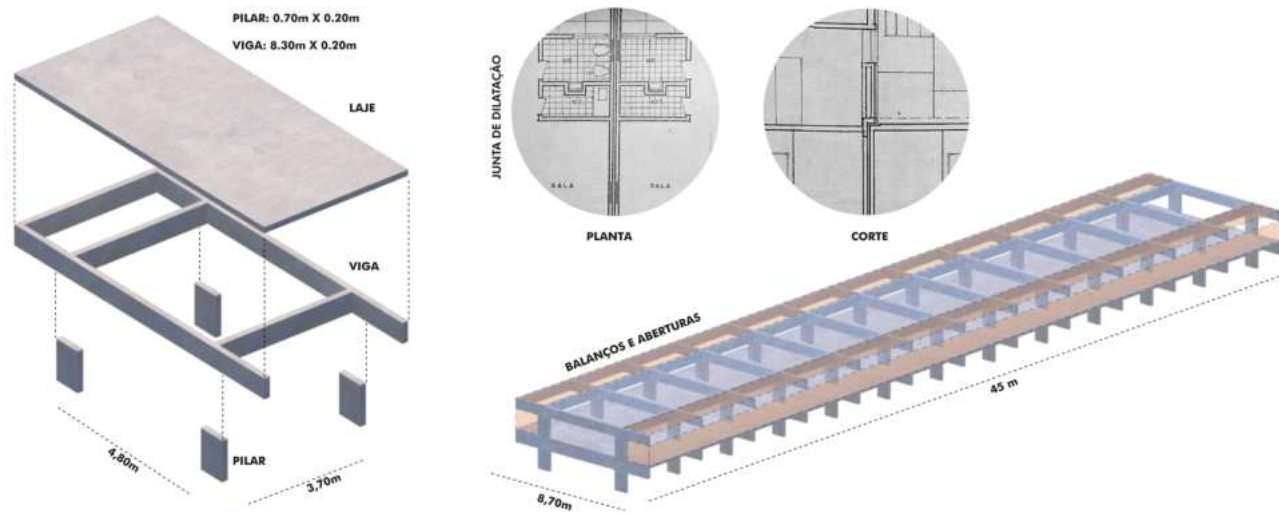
Esquemática da estrutura existente (módulo gerador e junta de dilatação).
